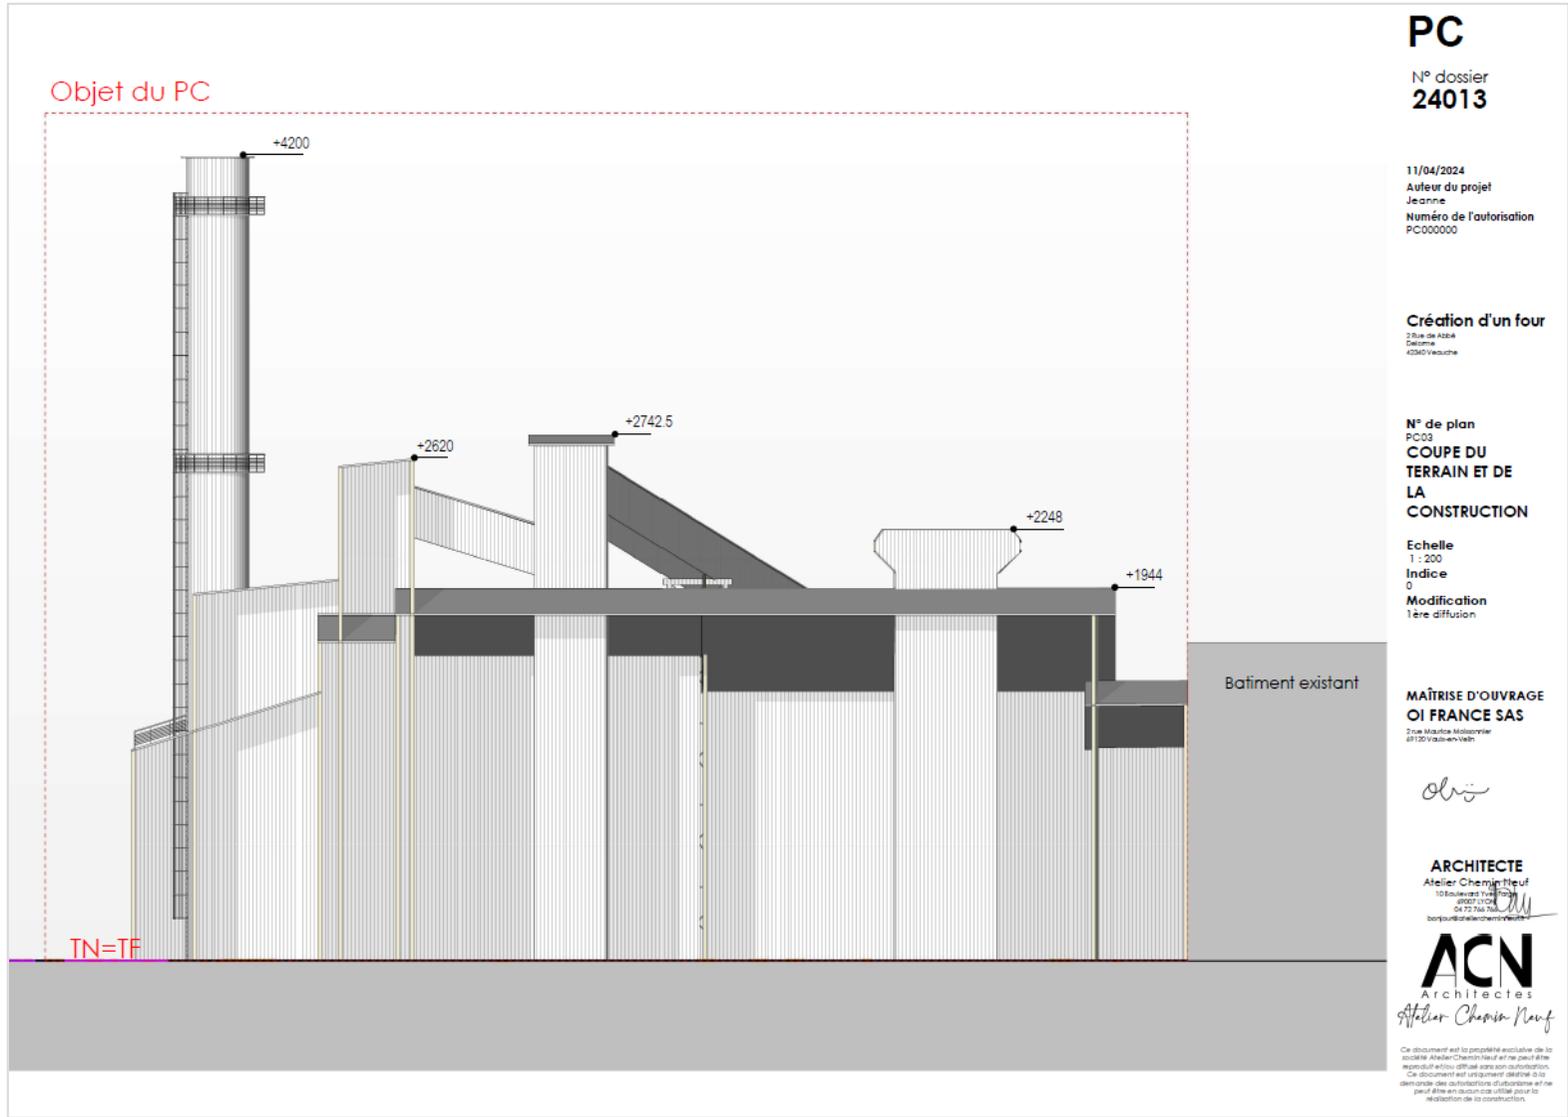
Zone d'implantation du projet de rehaussement de toiture (source : permis de construire lié au rehaussement de toiture)
